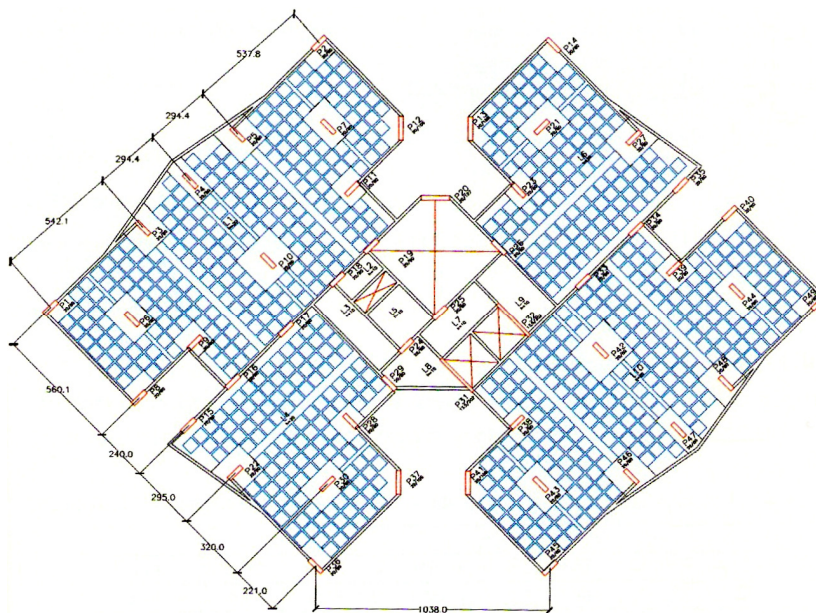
Planta baixa do terceiro exemplo (MARTINS, 2003)
